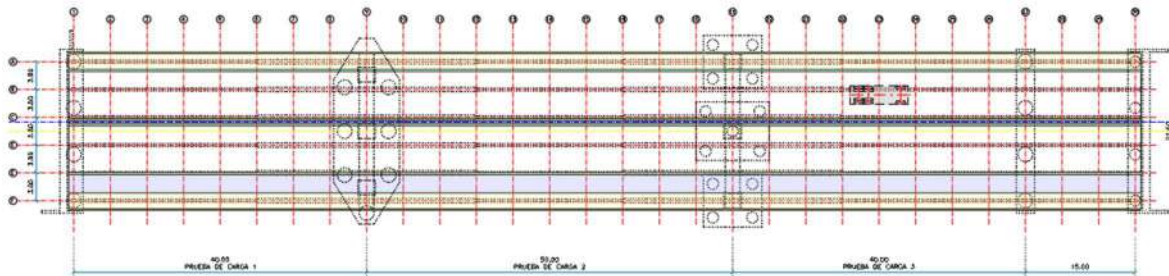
Posicionamiento de cargas, Prueba 3 – 1Camión (P3C1).
